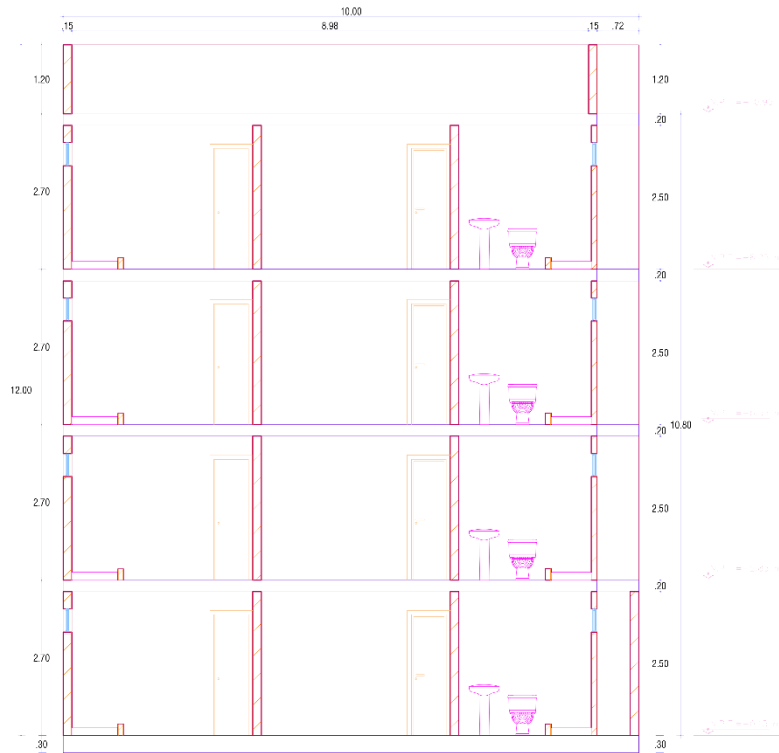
Plano Arquitectónico de Corte en Elevación C-C'.
